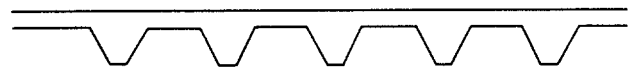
Excepción N° 4 Construcción típica con viguetas de concreto.
